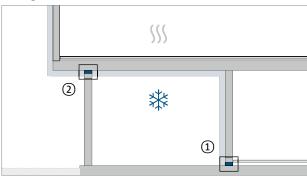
Mur extérieur de garage souterrain et poteau avec Schöck Sconnex®
